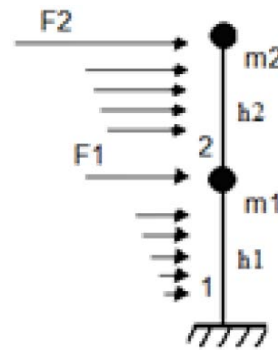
Distribución de cargas horizontales sobre pilares y centro de masa en edificio de dos pisos.
